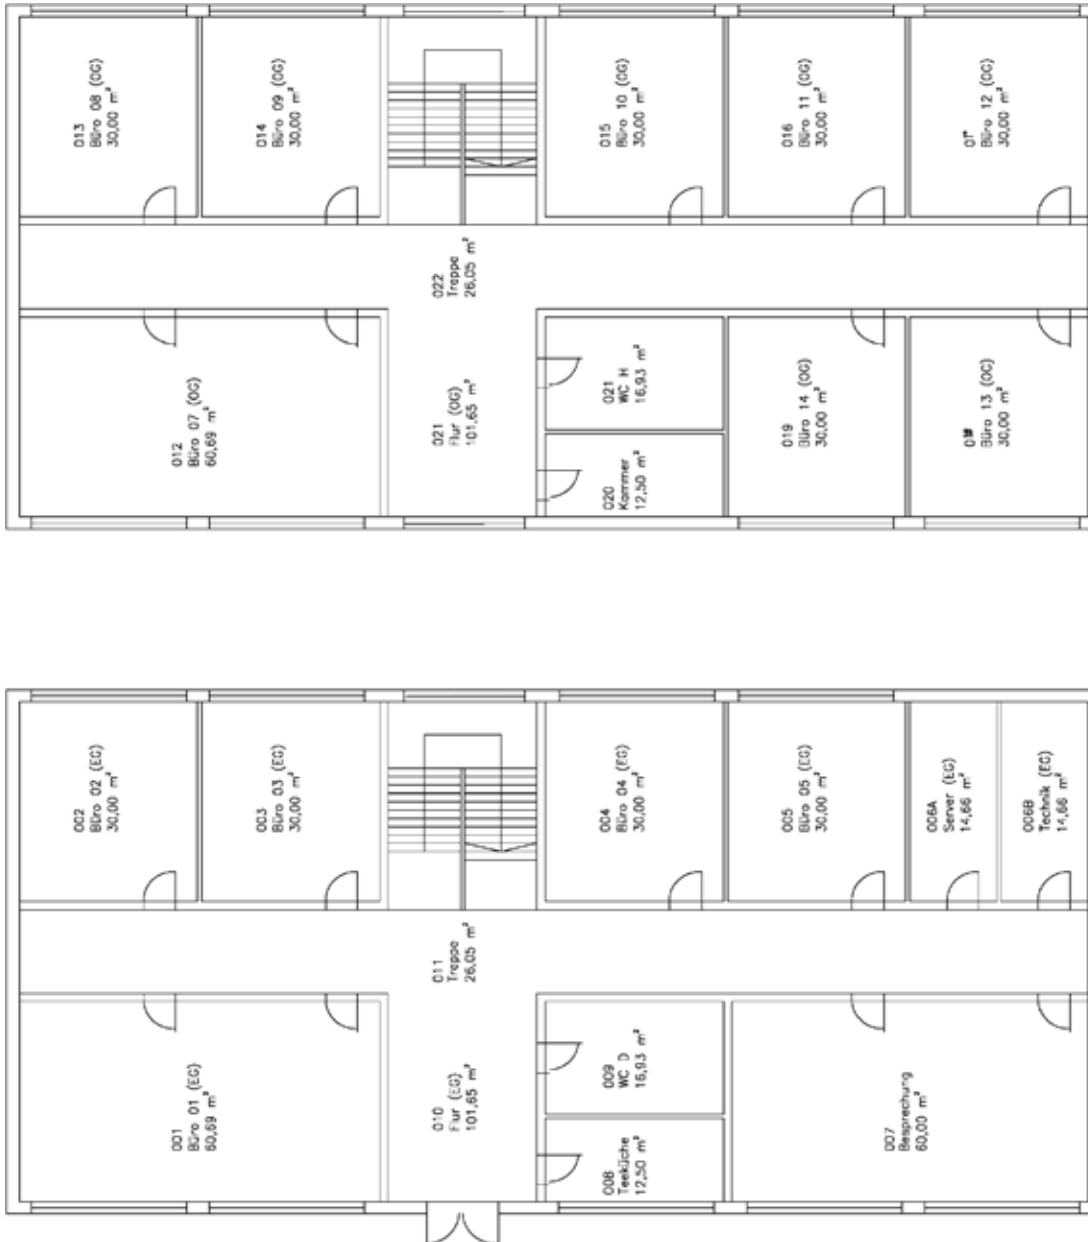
Grundriss eines zweigeschossigen Bürogebäudes (unten: Erdgeschoss, oben: Obergeschoss) (OHM-MB-VS-ieg)
